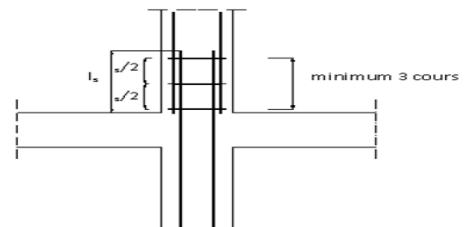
Les armatures transversales dans la zone de recouvrement.
